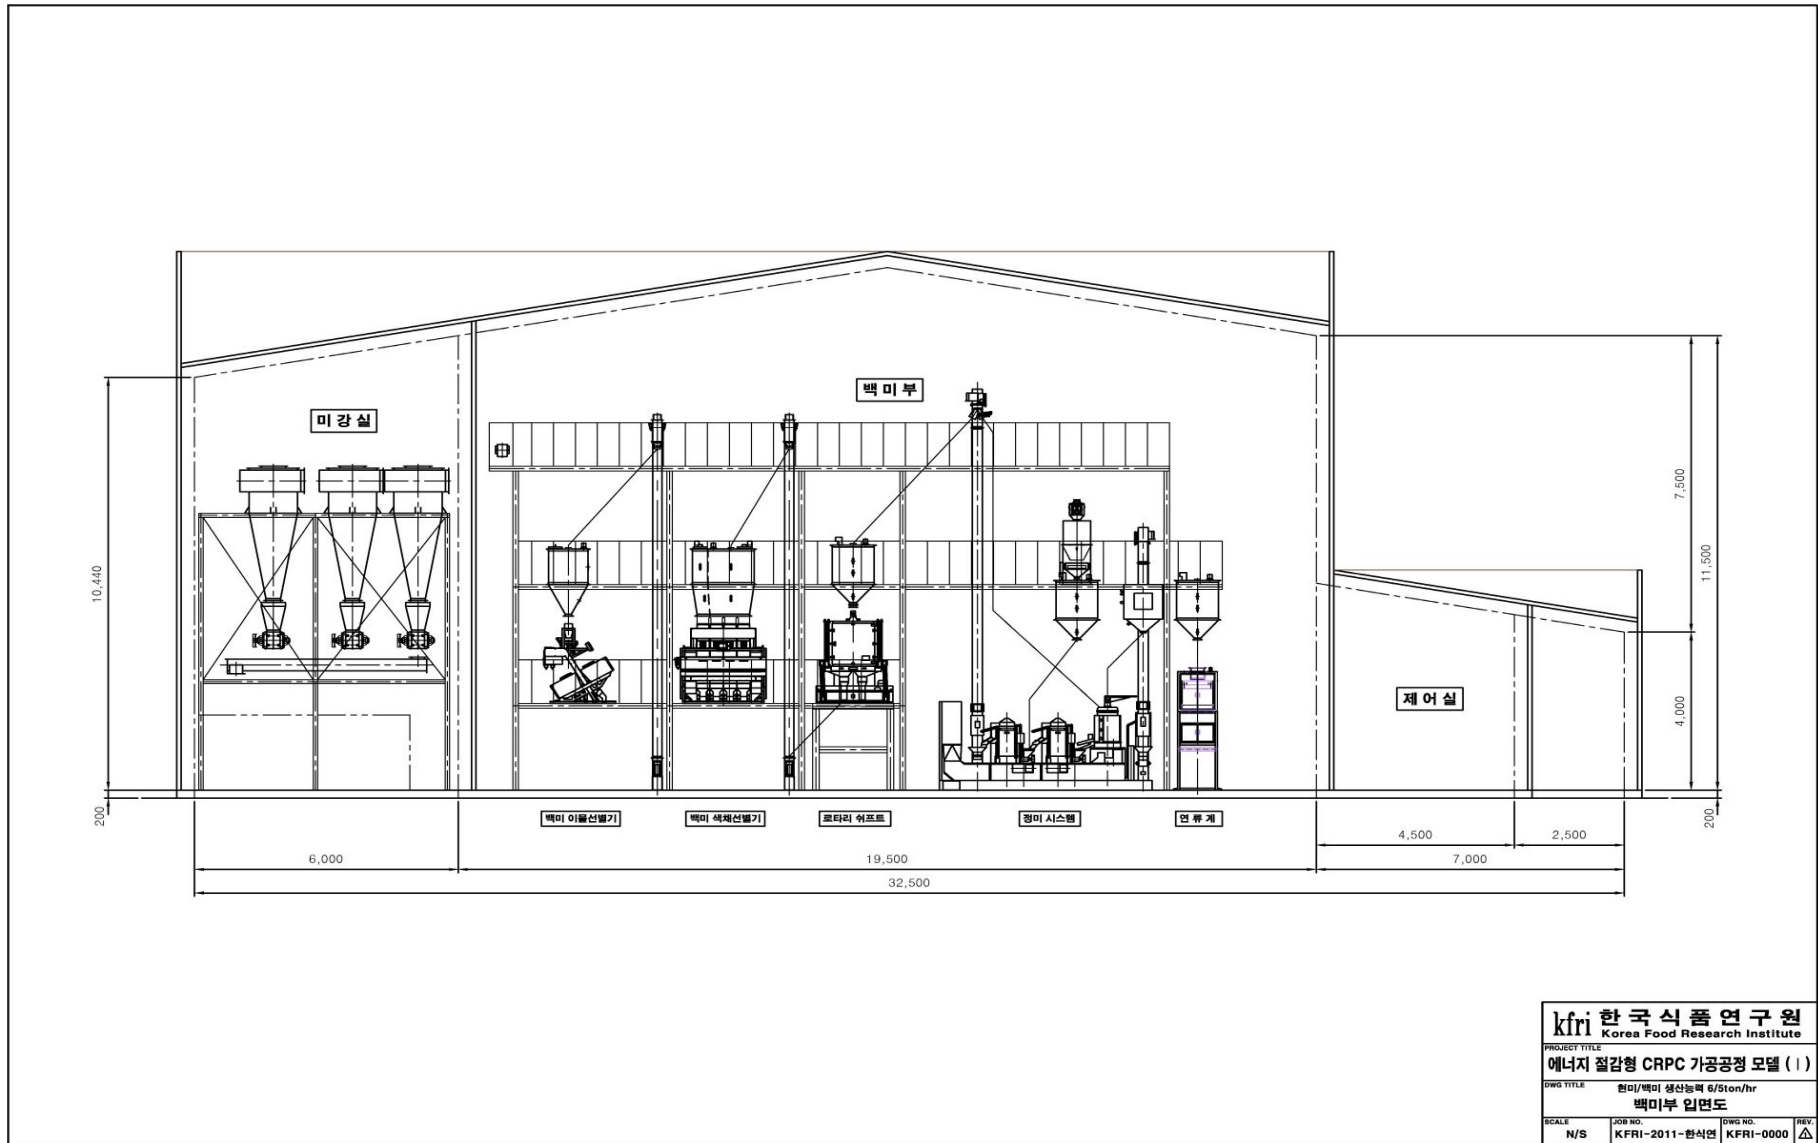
현미/백미생산능력 6/5ton/hr인 에너지절감형 가공공정 모델(I)의 백미부 입면도
